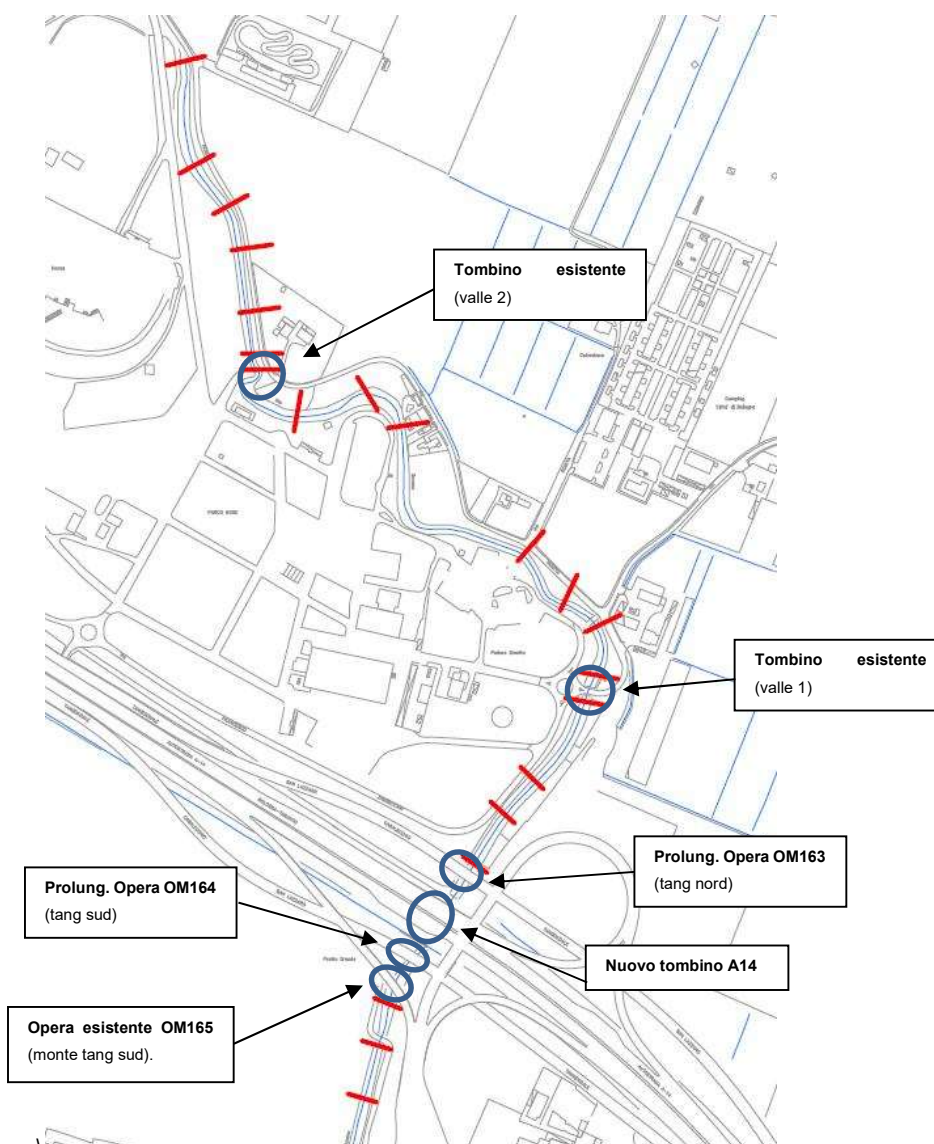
Planimetria sezioni HEC-RAS, canale Savena Abbandonato con individuazione delle opere esistenti
